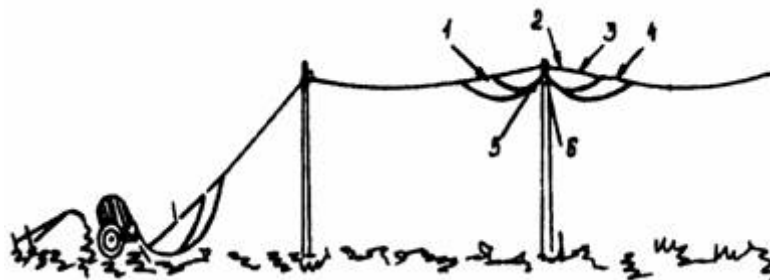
Схема натягивающего приспособления в конце участка ВЛИ:
